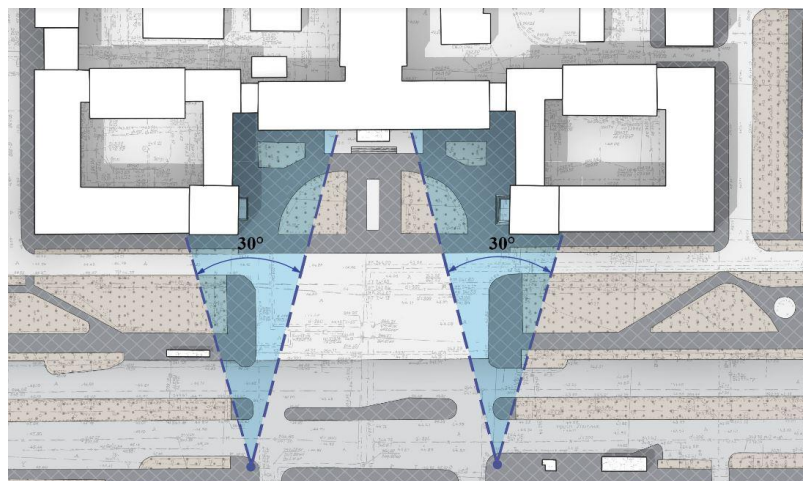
Моделирование зоны визуального восприятия на фасаде светового ансамбля
